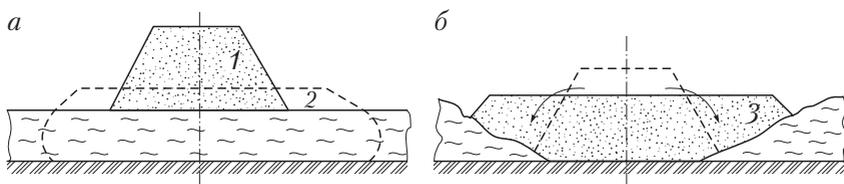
Схема посадки насыпи на дно болота методом перегрузки: 1 — временное сечение отсыпаемой насыпи; 2 — проектное сечение земляного полотна; 3 — реальное сечение земляного полотна после завершения работы
